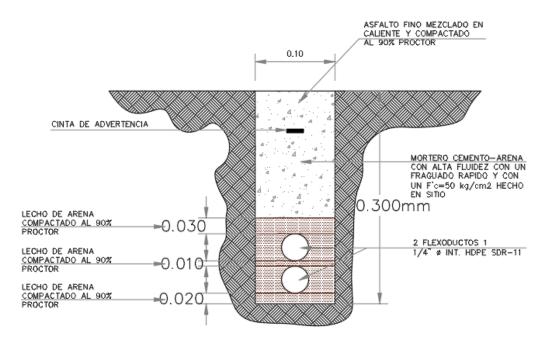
DETALLE DE CEPA PARA INSTALACIÓN SUBTERRÁNEA.
